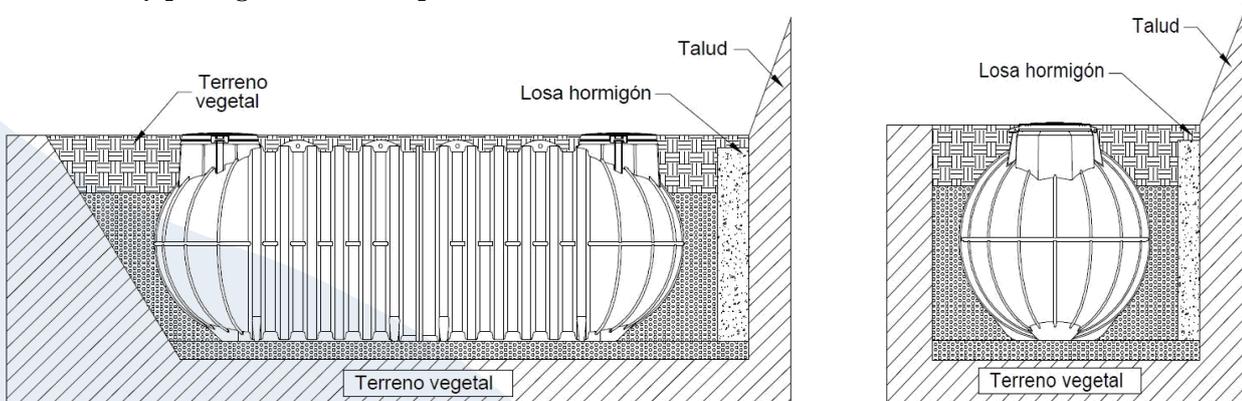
Ilustración VIII: Colocación de losa de hormigón vertical en terrenos inclinados.
